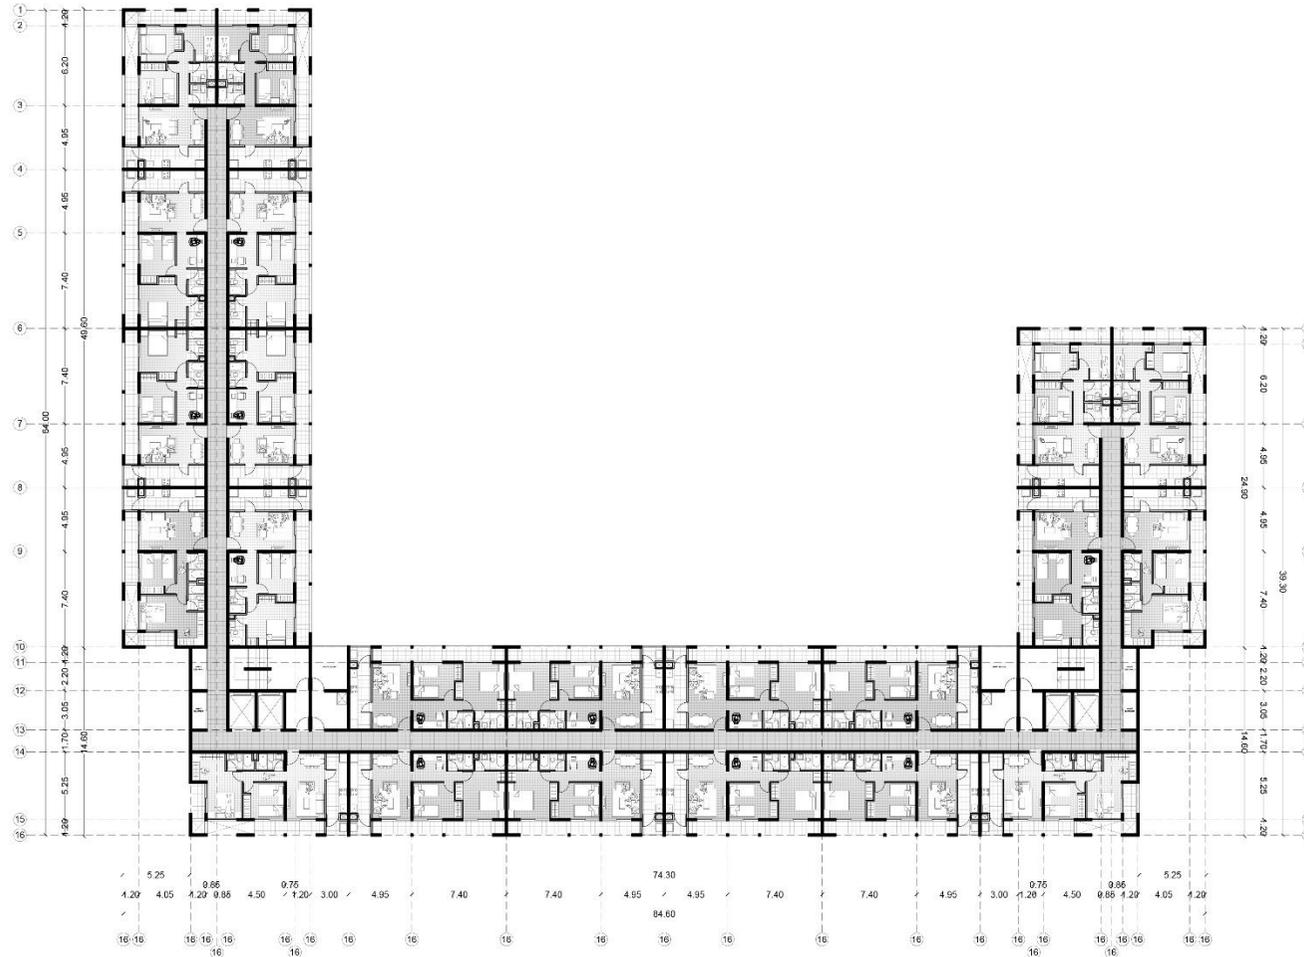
Planta tipo edificio 6/8 pisos, escala 1/300. Fuente: Elaboración propia.
